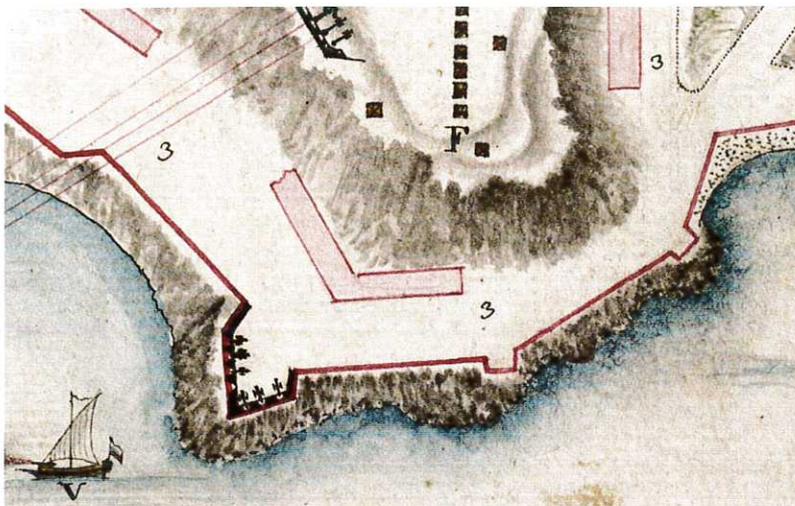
Plan vers 1793 avec le bastion ouest toujours présent sur la pointe de Rauba Capeu (cl. E. Guilloteau - INASS).
